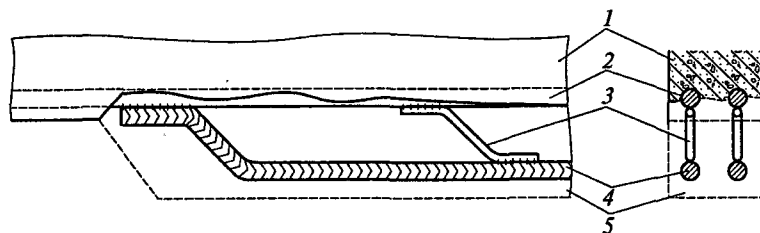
Увеличение высоты сечения изгибаемого железобетонного элемента:
